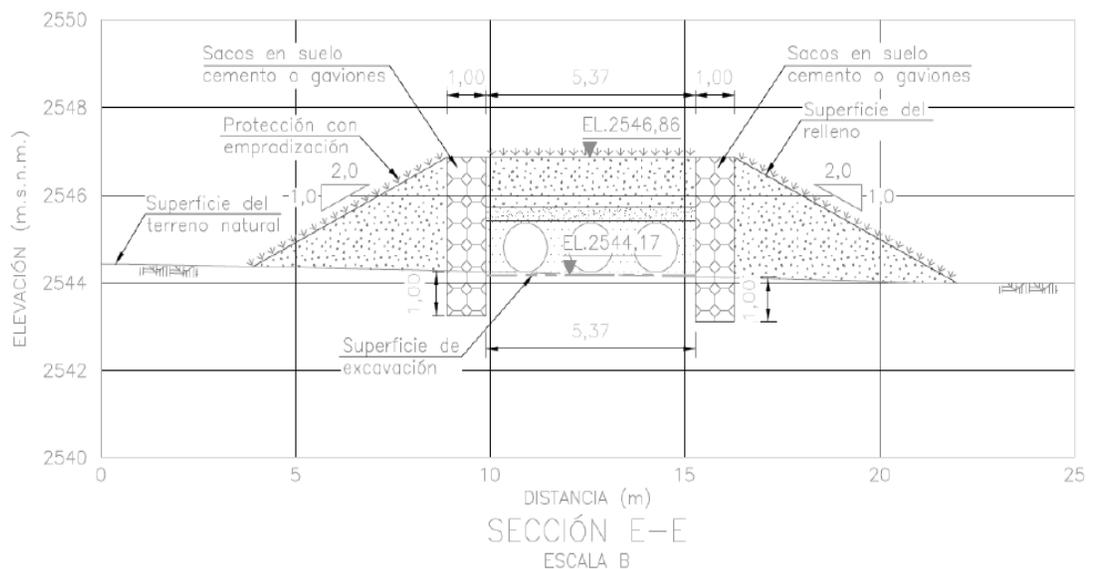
Perfil transversal de la estructura de descarga. Se muestra la estructura en el sector donde presenta las 3 tuberías de descarga y los gaviones, esto sobre la zona de manejo y preservación ambiental del CER del Río Fucha. *Fuente: Radicado EAB ESP No. 2016ER58931.
